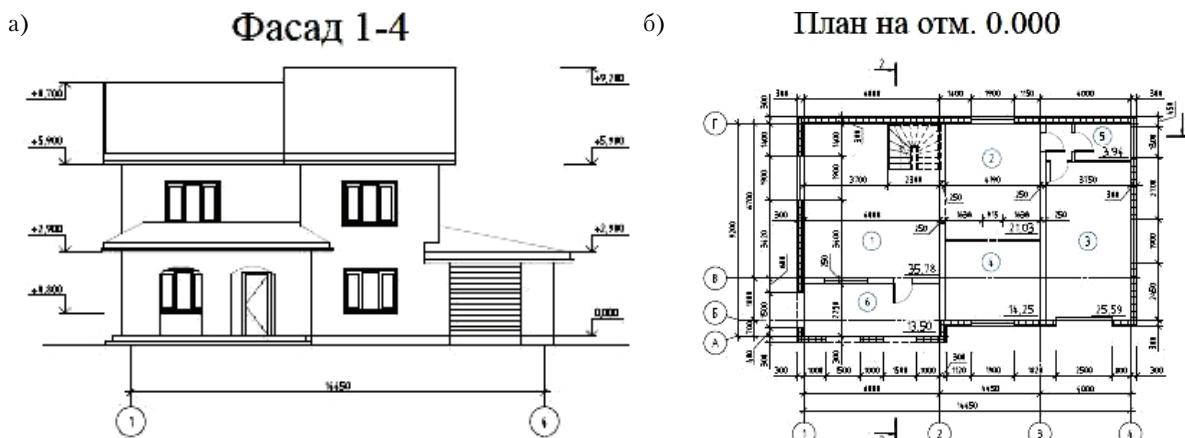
Архитектурно-планировочное решение коттеджа (план и фасад).
